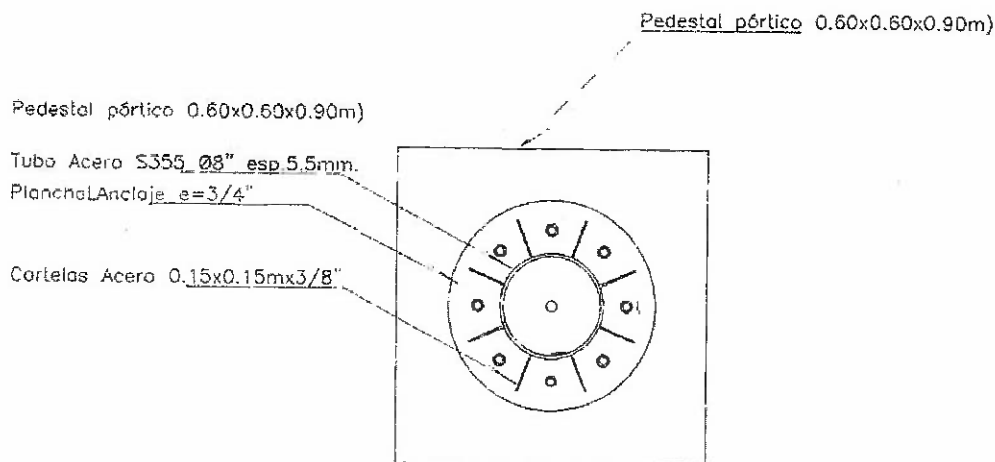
Plancha de Anclaje de las columnas cartelas y pernos de anclaje del Pórtico para RFID
